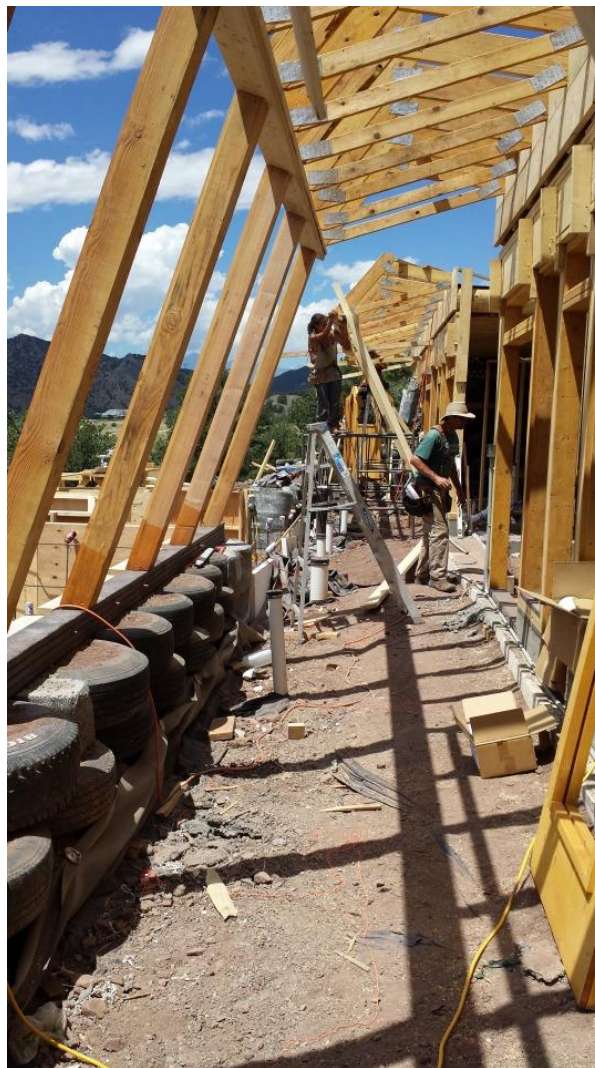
Estructura de madera del invernadero (Fuente: SailingheearthWordpress).
